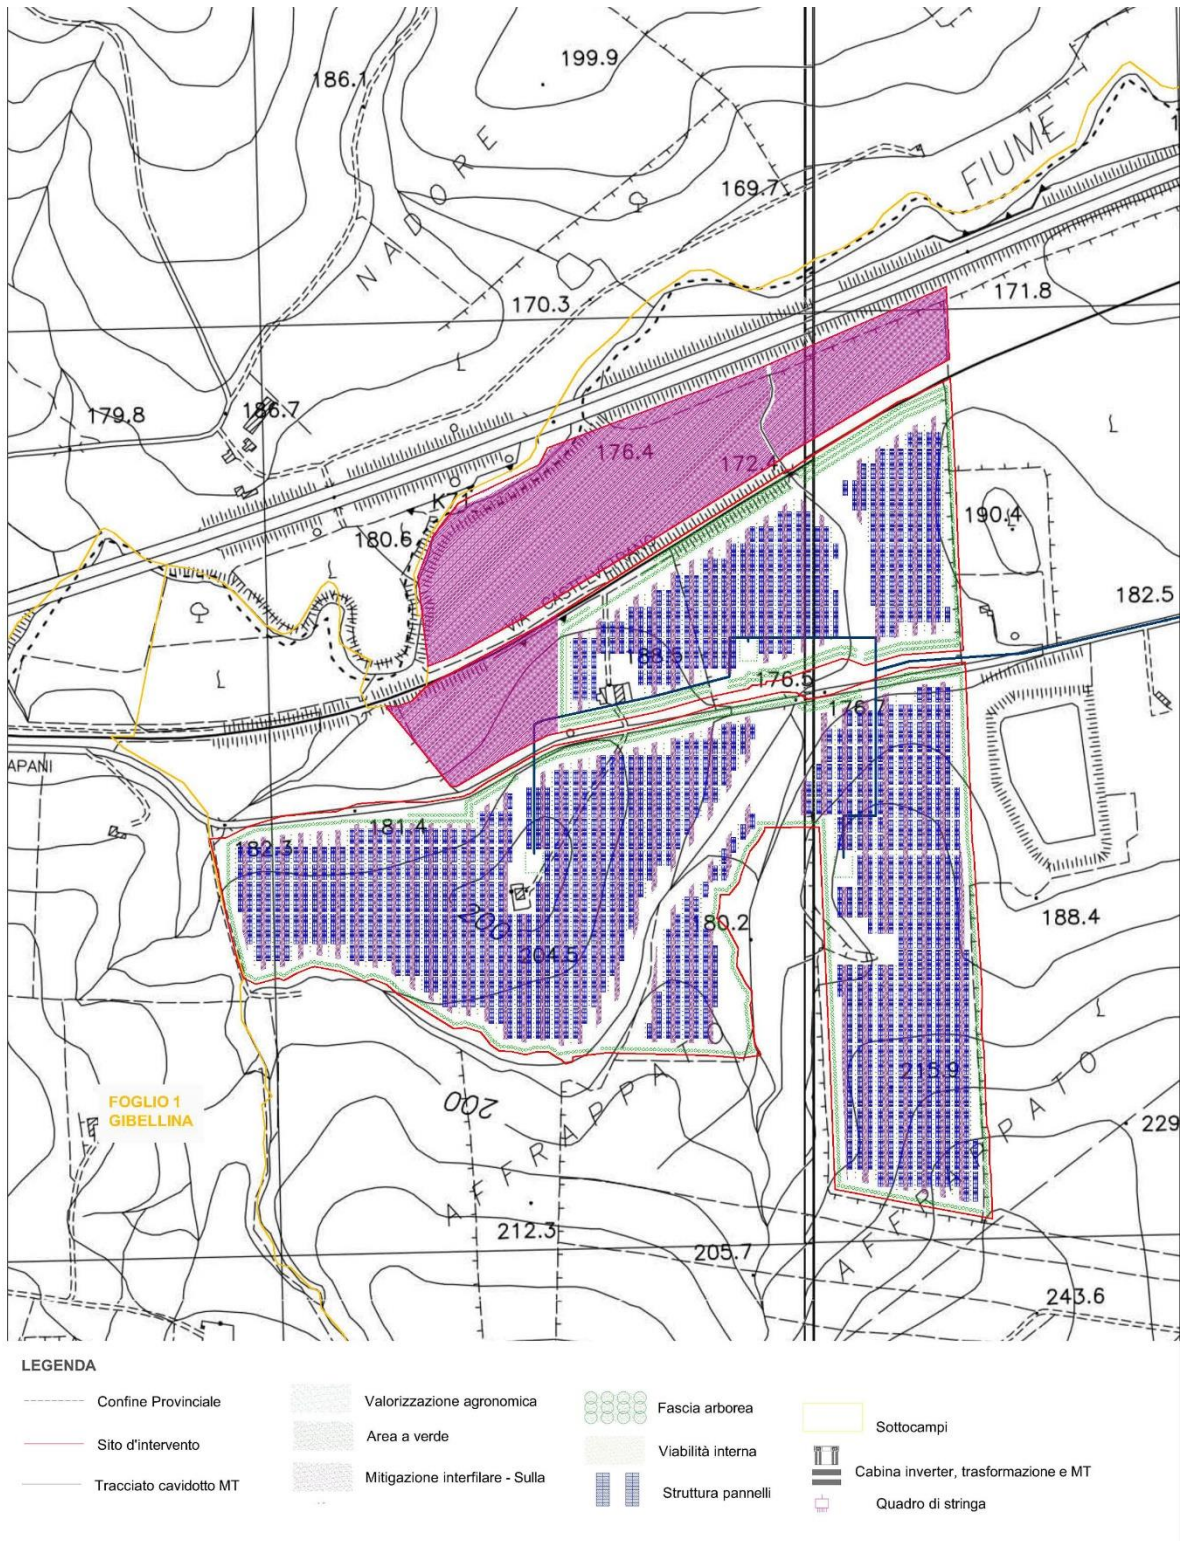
B – Layout dell'impianto ricadente in Contrada Magione con cavidotto
